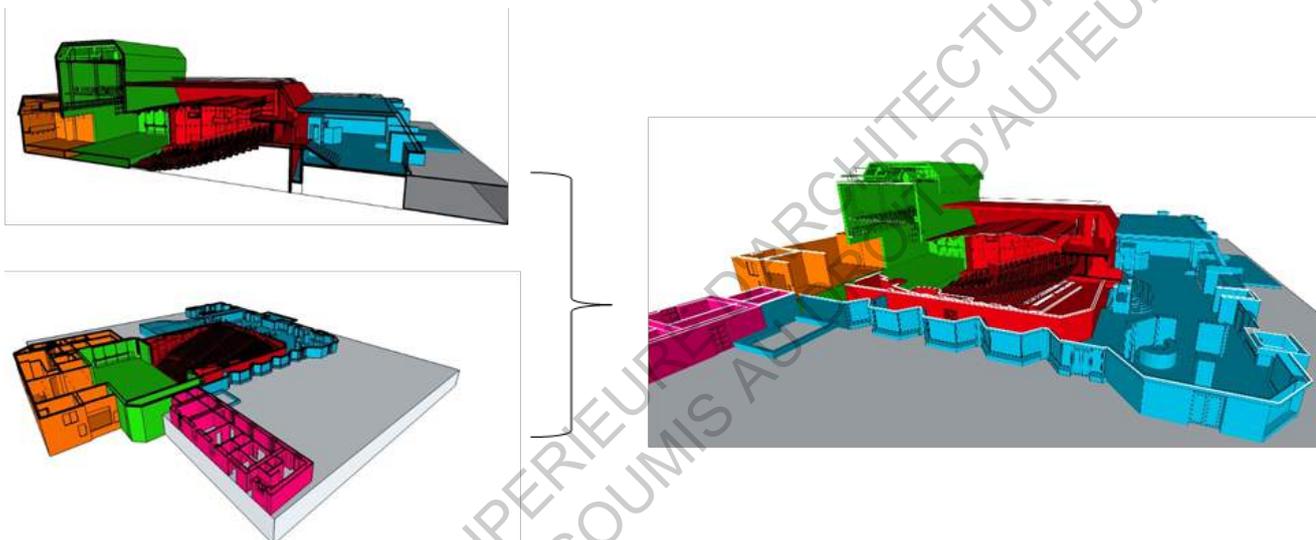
Schéma d'intention de la future maquette, à la croisée entre plan et coupe tactile
